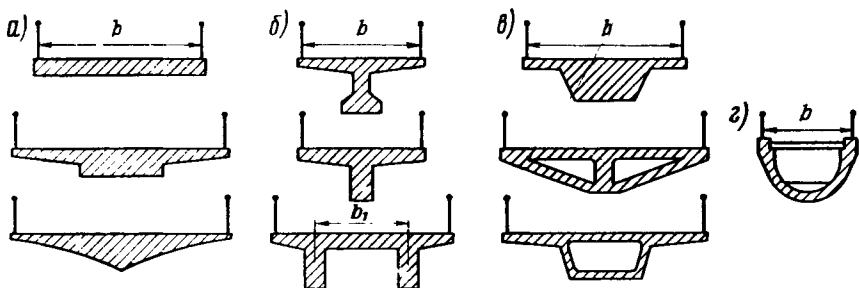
Типы поперечных сечений железобетонных пешеходных мостов
